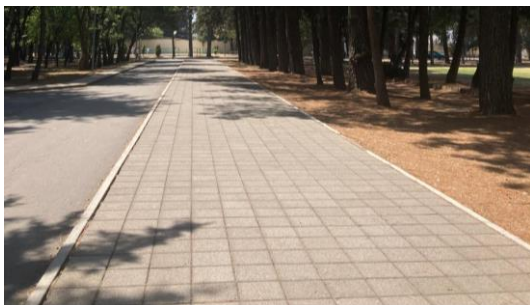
Pavimentos de la explanada central. Fuente: Elaboración propia.
